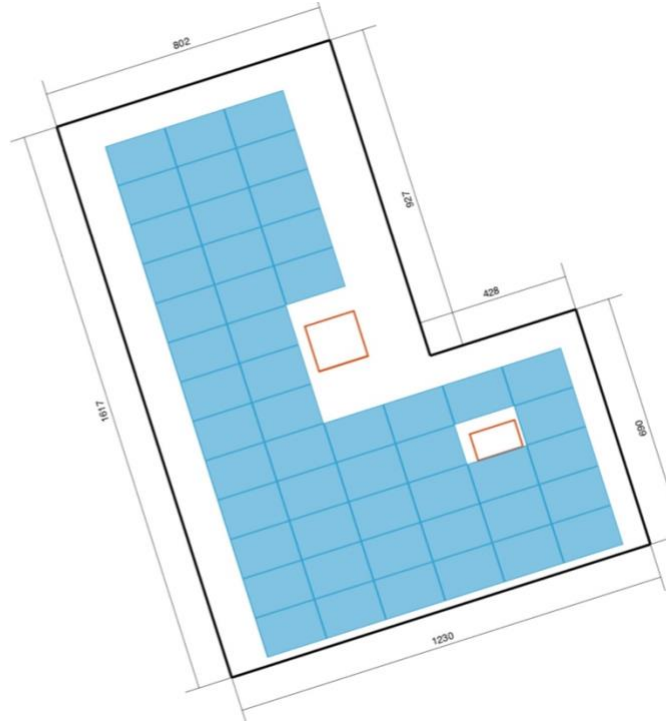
Rickenstrasse 50, Belegungsplan, Dachfläche 2: Ost
